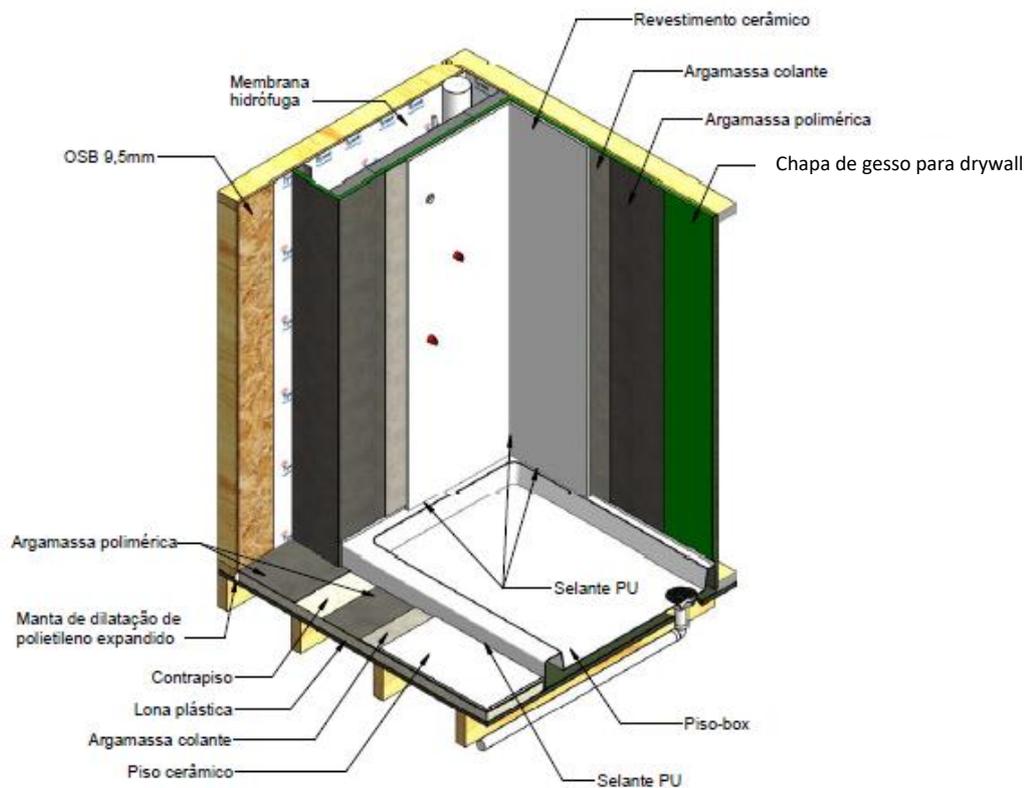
Detalhe de interface entre piso interno de áreas molhadas e base de paredes de fachada (laje plana) – sem escala.
